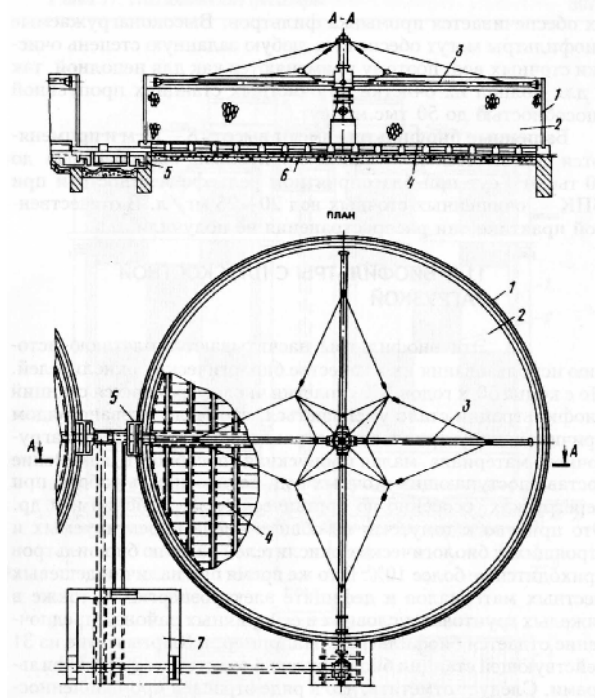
Высоконагружаемый биофильтр: 1 - корпус; 2 - загрузка; 3 - реактивный ороситель; 4 - дренажная решетка; 5 - гидравлический затвор; 6 - сплошное днище; 7 - вентиляционная камера
